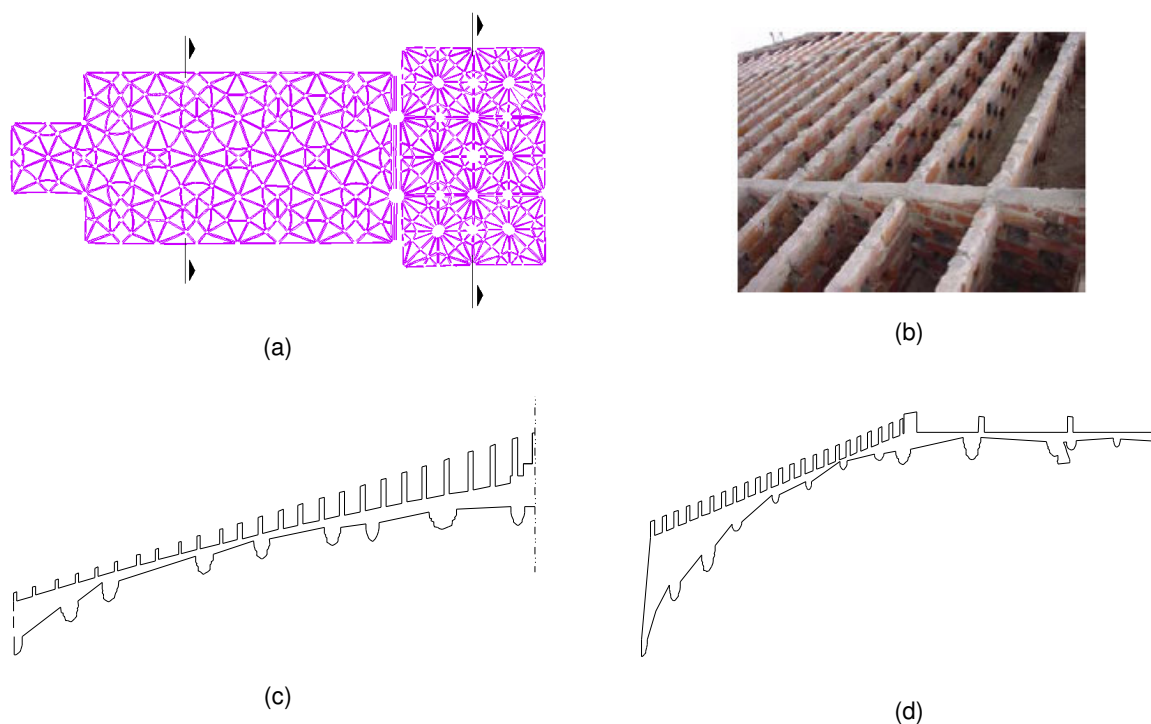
Cconstituição das abóbadas e sua cobertura: (a) planta do intradorso das abóbadas da nave e transepto com localização dos cortes; (b) muretes em alvenaria de tijolo para assentamento do telhado; (c) corte transversal à nave; (d) corte transversal ao transepto.
